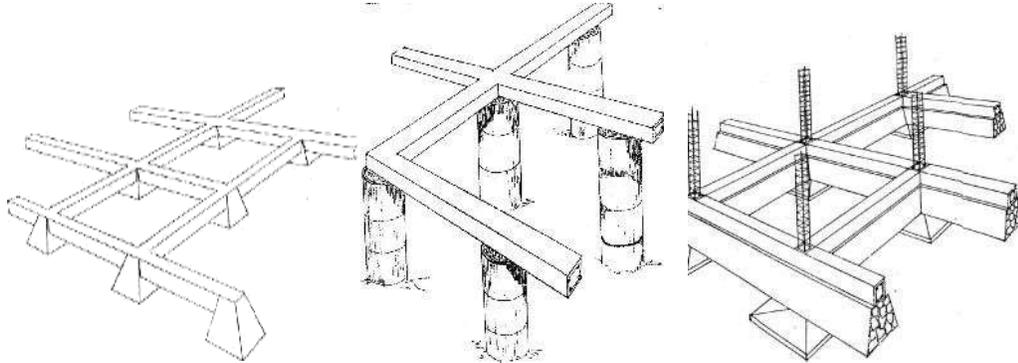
Pondasi Pilar dan Sumuran dan Telapak
